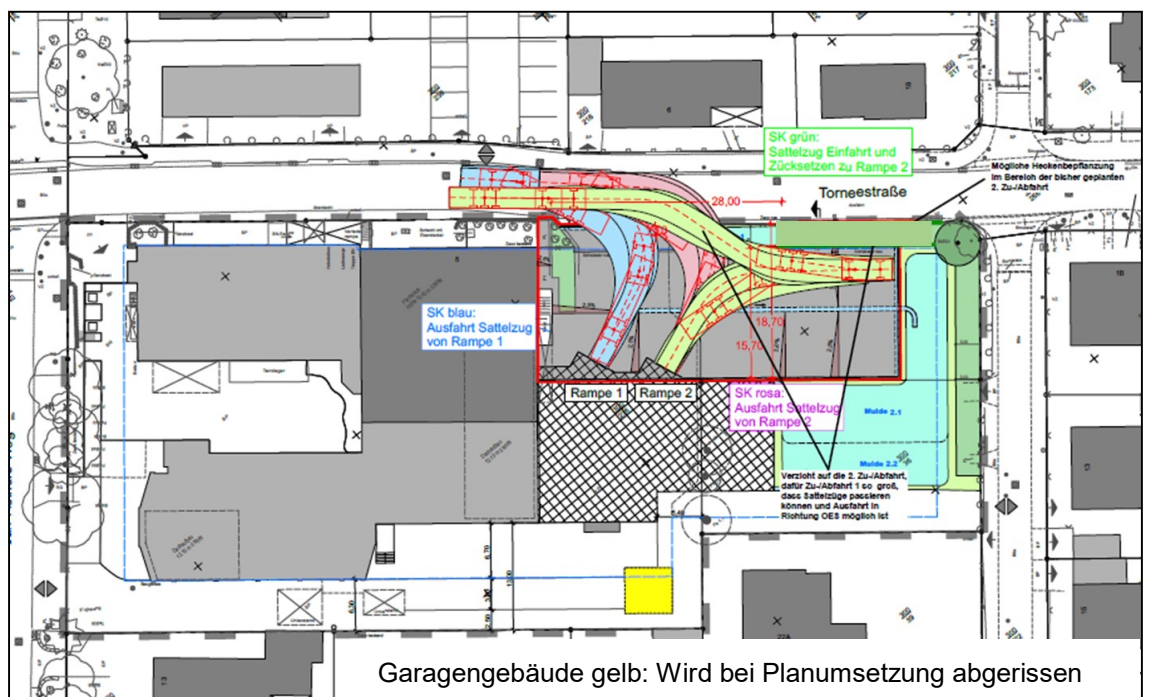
Lageplan mit den Rangierflächen (Fahrspur blau: Ausfahrt Sattelzug Rampe 1, Fahrspur grün: Einfahrt und Zurücksetzen zu Rampe 2, Fahrspur rosa: Ausfahrt Sattelzug von Rampe 2; schwarz-weiß schraffierte Fläche: Hallenneubau) (Quelle: Ingenieurbüro Kleberg & Partner, Stand: 11.08.2020)
